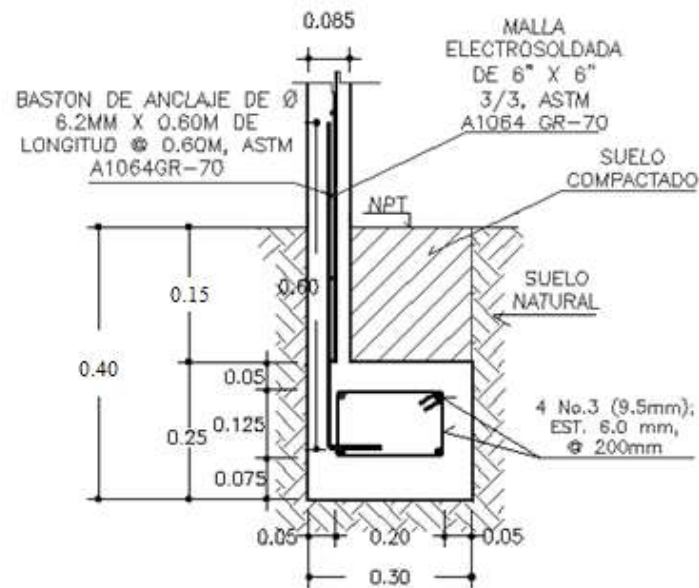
b Detalle típico de solera de fundación, vivienda de una planta
